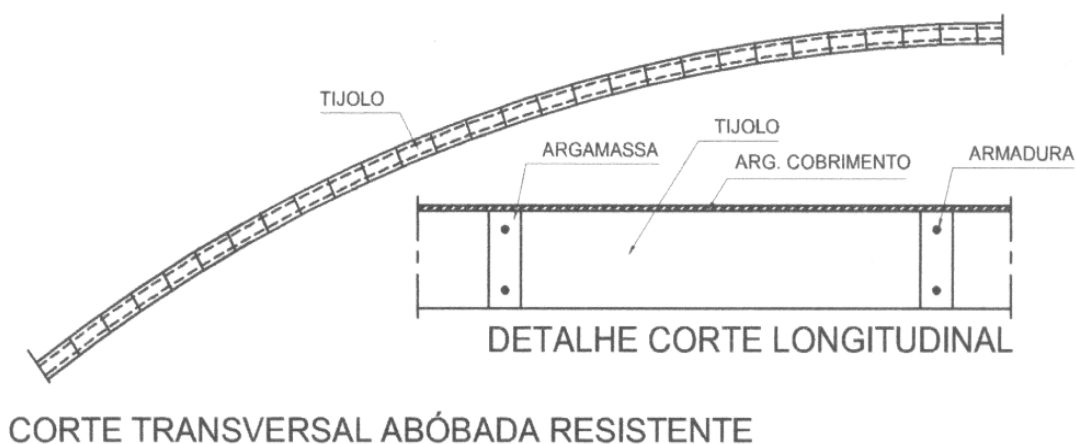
Casa Berlinghieri: corte transversal e detalhe em corte longitudinal da abóbada autoportante (DIESTE, 1947).
